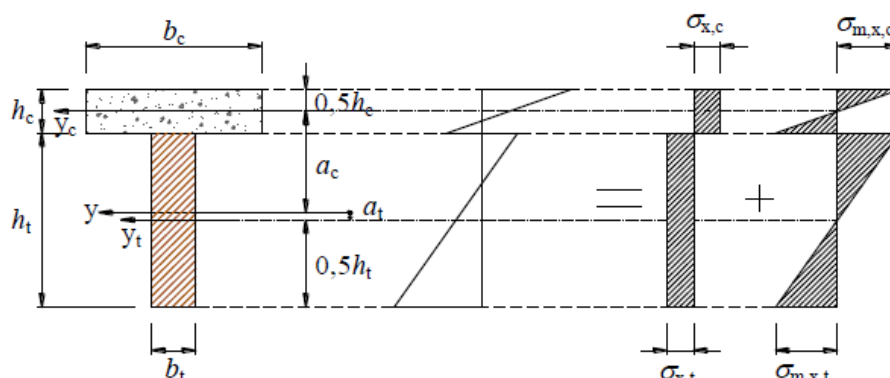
Parâmetros utilizados na determinação das tensões na secção transversal de uma viga mista madeira-betão (Fonte: Rodrigues,2014).
